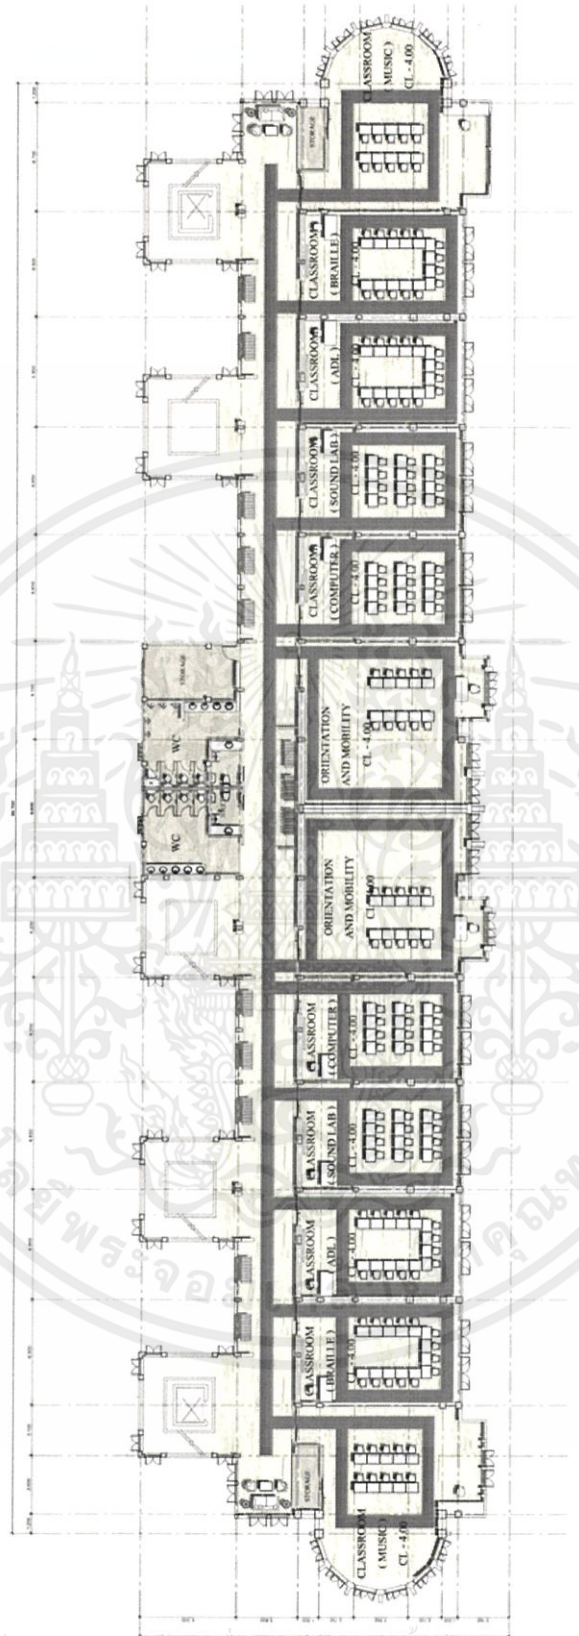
แสดงการนำเสนอ PLAN 1st FLOOR
